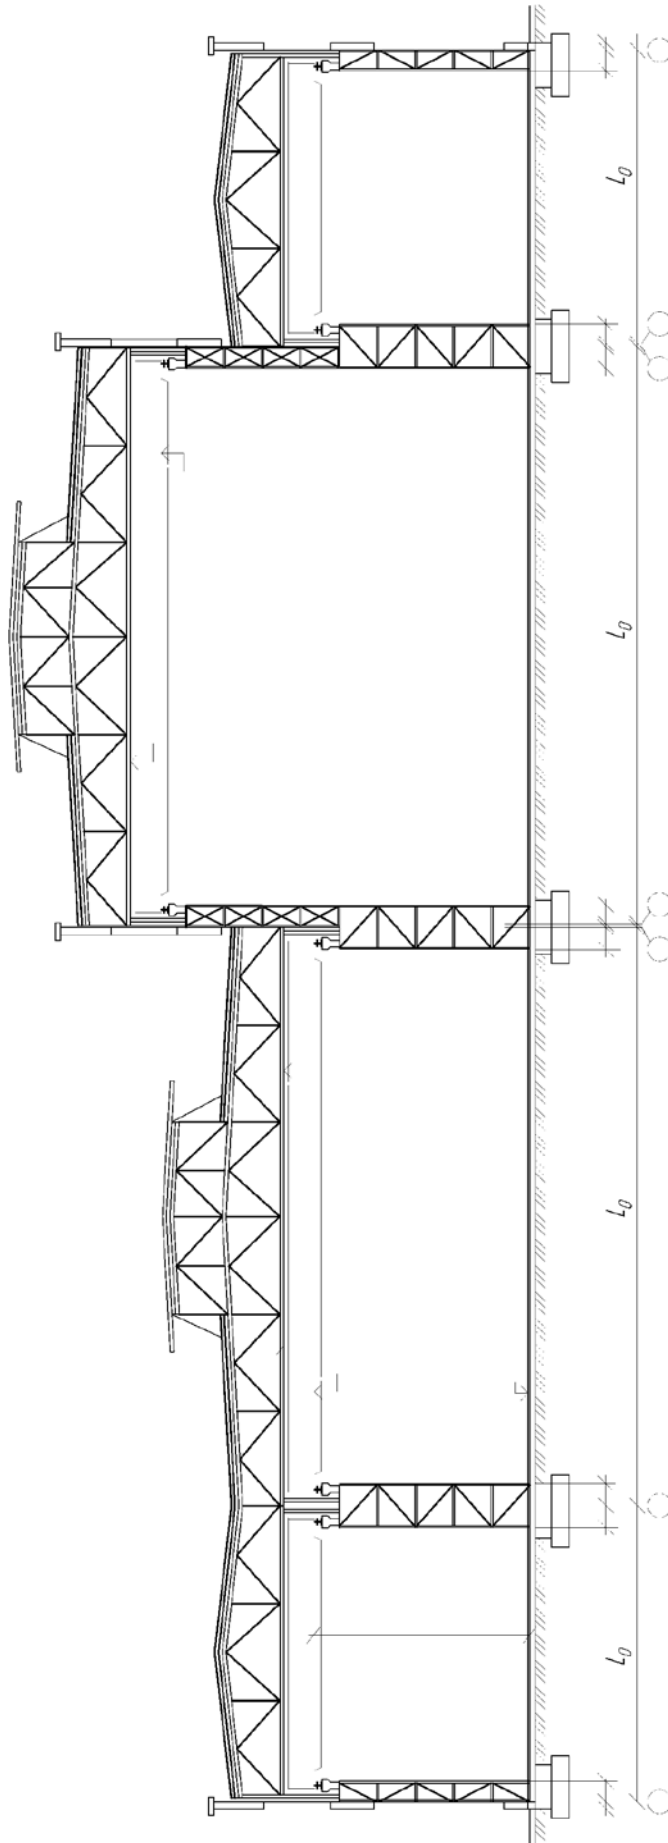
Схема многопролетного промышленного здания с разными пролетами и стальным каркасом
